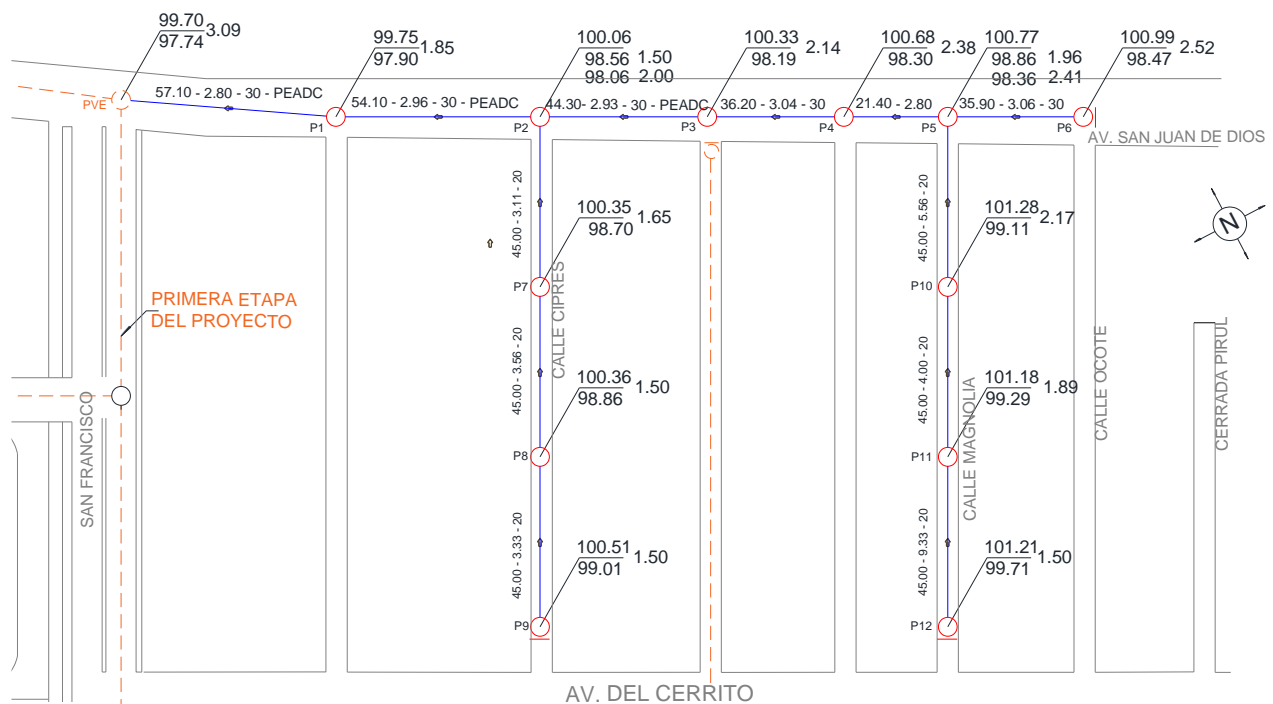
Planta de proyecto terminado (As Build) en San Martín Xico Nuevo.
